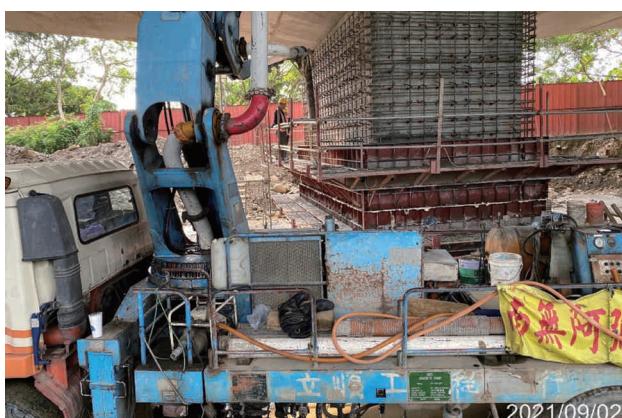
第 M37D 標 名間高架橋 P25R 墩柱混凝土包覆施工
